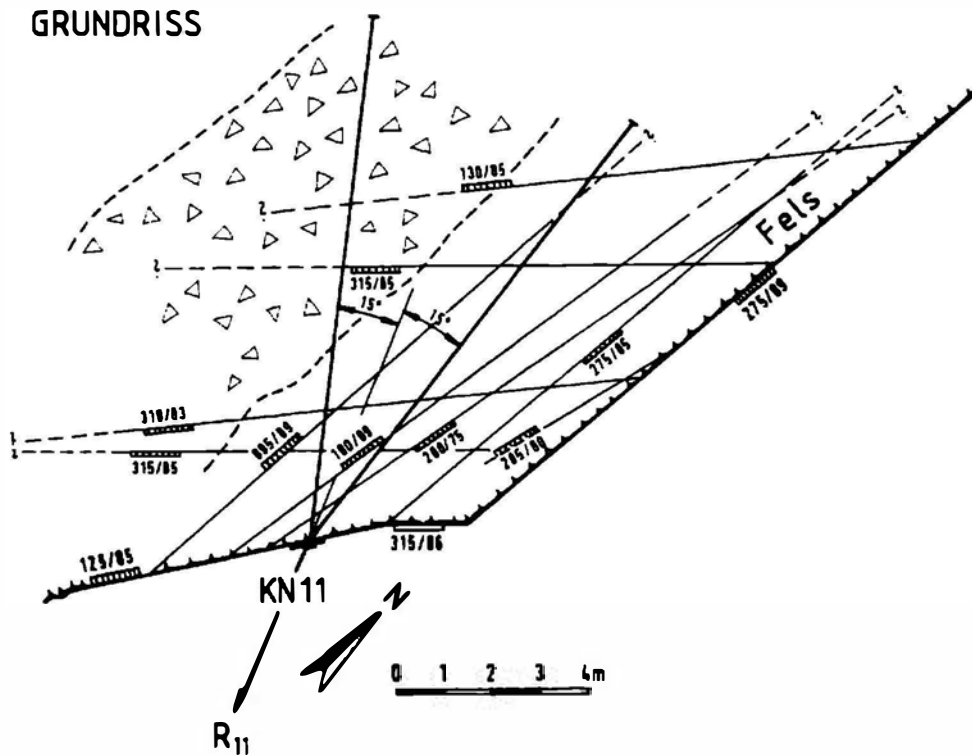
Grundrisschema der Ankerbohrungen sowie schleifender Verschnitt der Bohrung Knoten 11-unten
